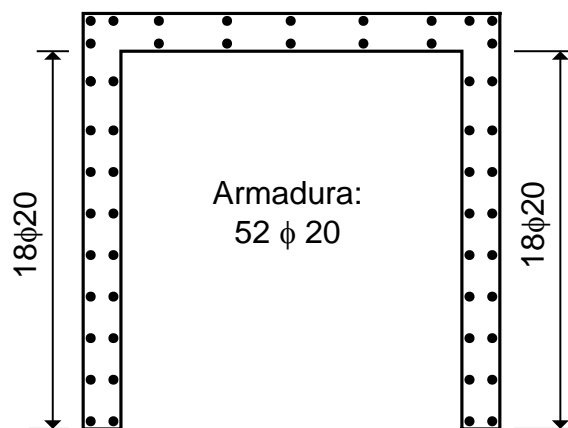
Seção transversal do pilar-parede com consideração da flambagem local
